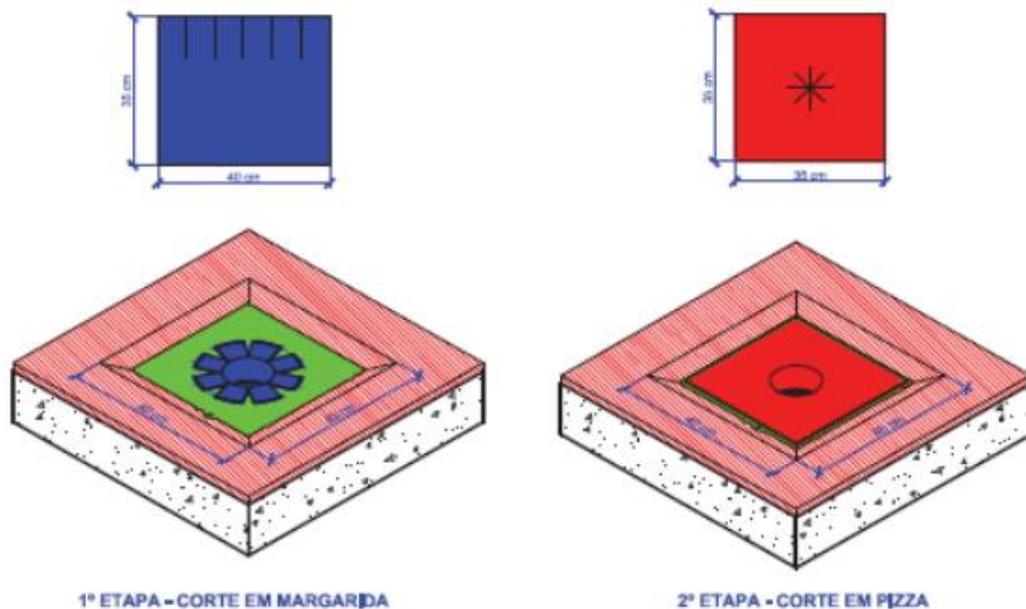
Aplicação de manta em corte margarida seguido de corte em pizza (VEDACIT, 2012).
